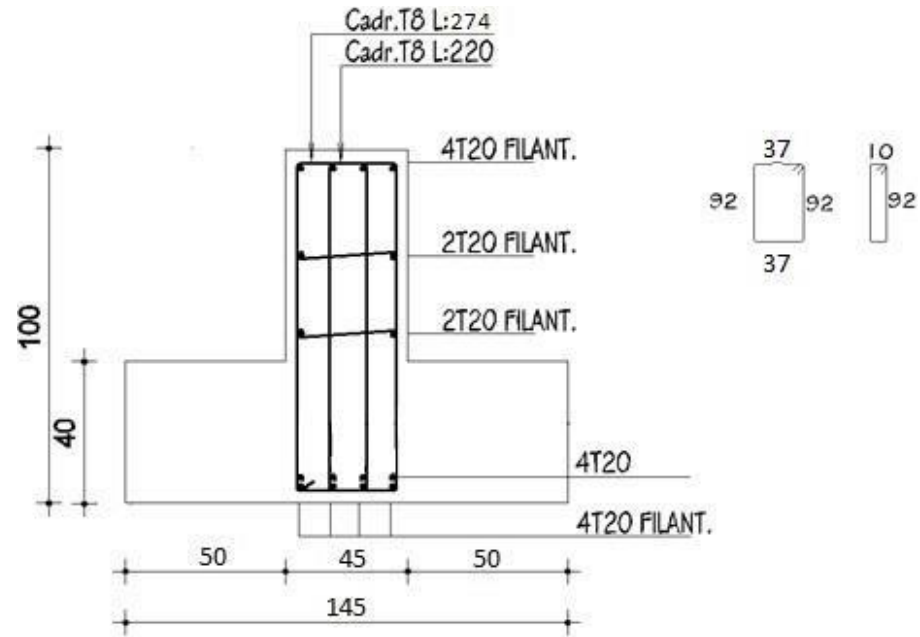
Dessin de ferrailage des poutres secondaires
